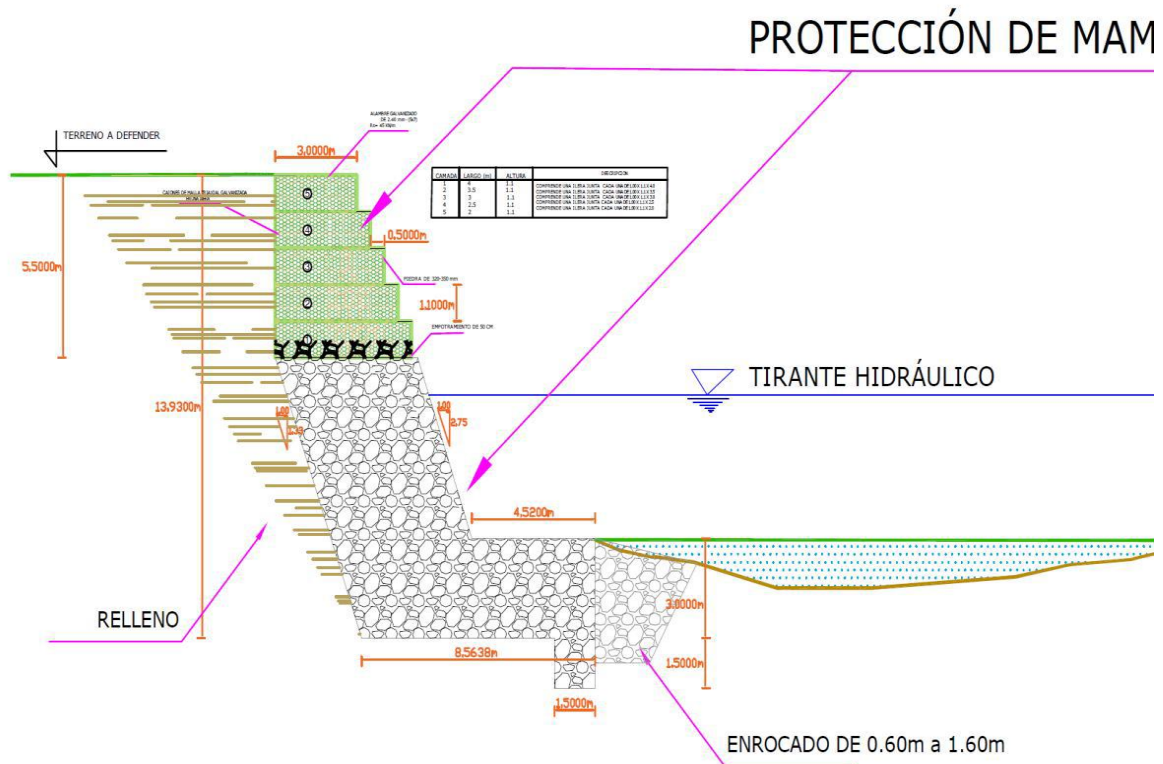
MURO DE MAMPOSTERÍA CON GAVIONES (trabajo propuesto para la protección de los estribos)
